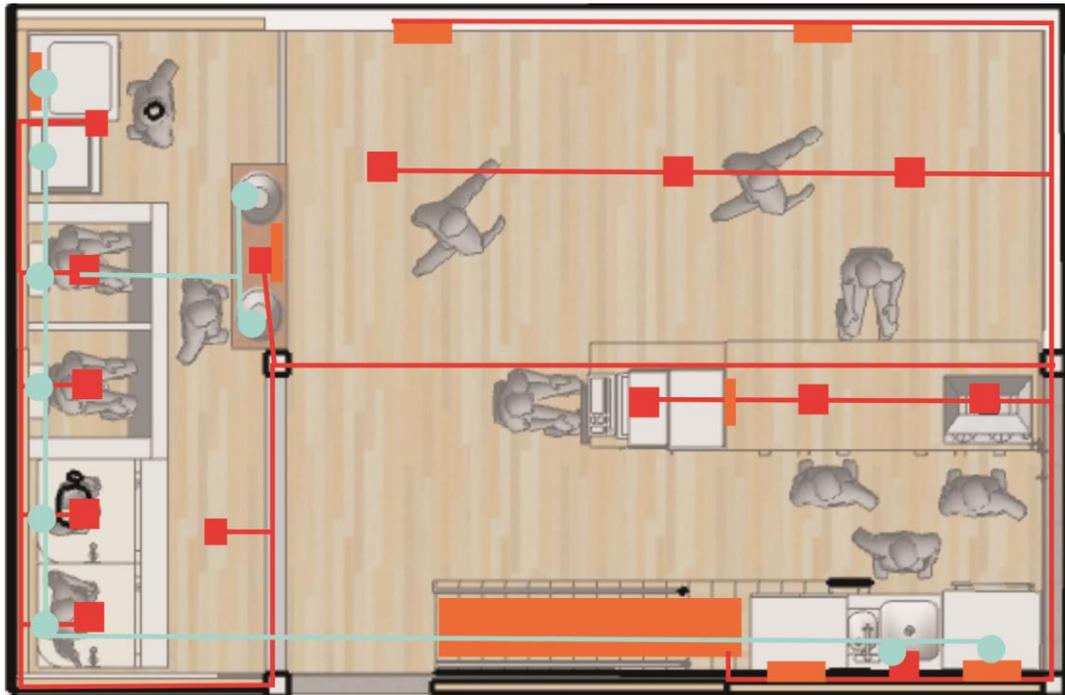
Planta baja. Distribución eléctrica e hidráulica.
